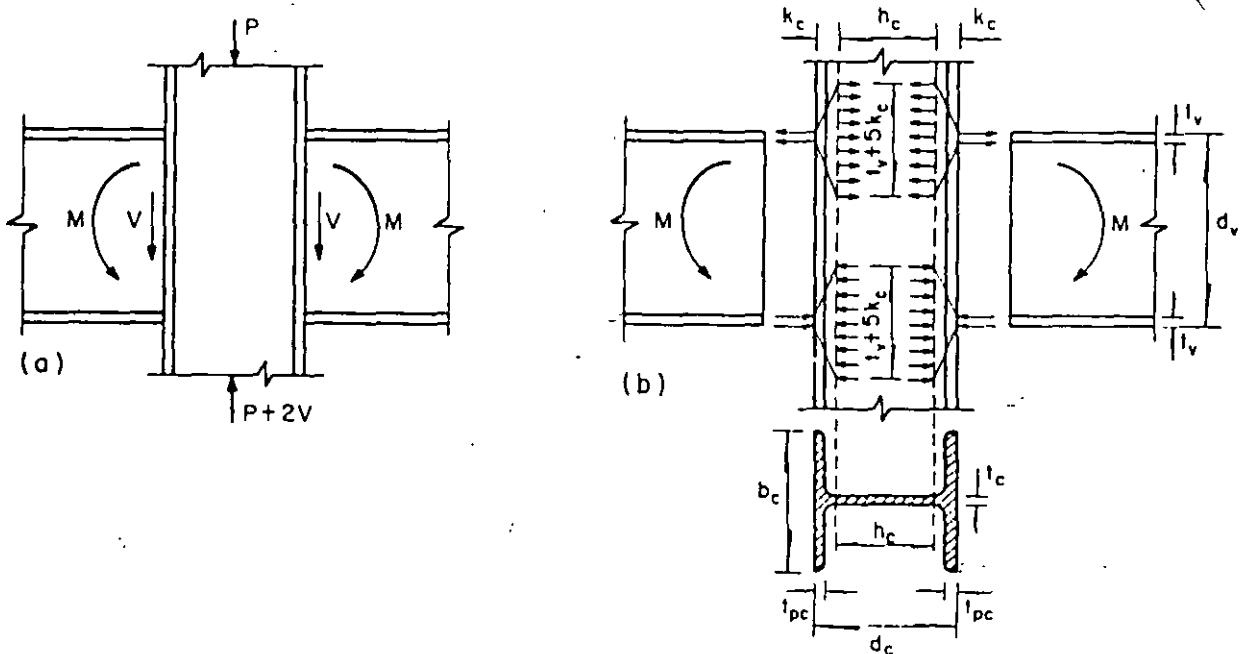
Conexión viga-columna con carga vertical simétrica. Acciones sobre la columna
